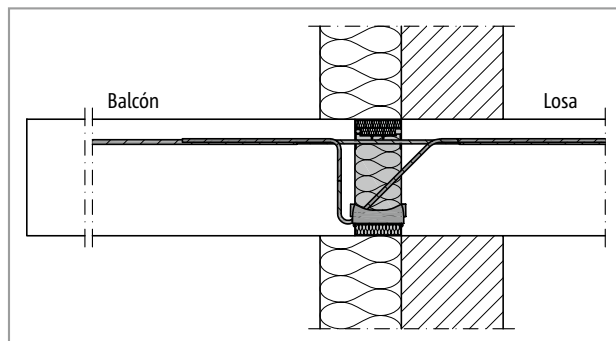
Schöck Isokorb® T tipo K: Conexión para sistema de aislamiento térmico exterior (SATE)
